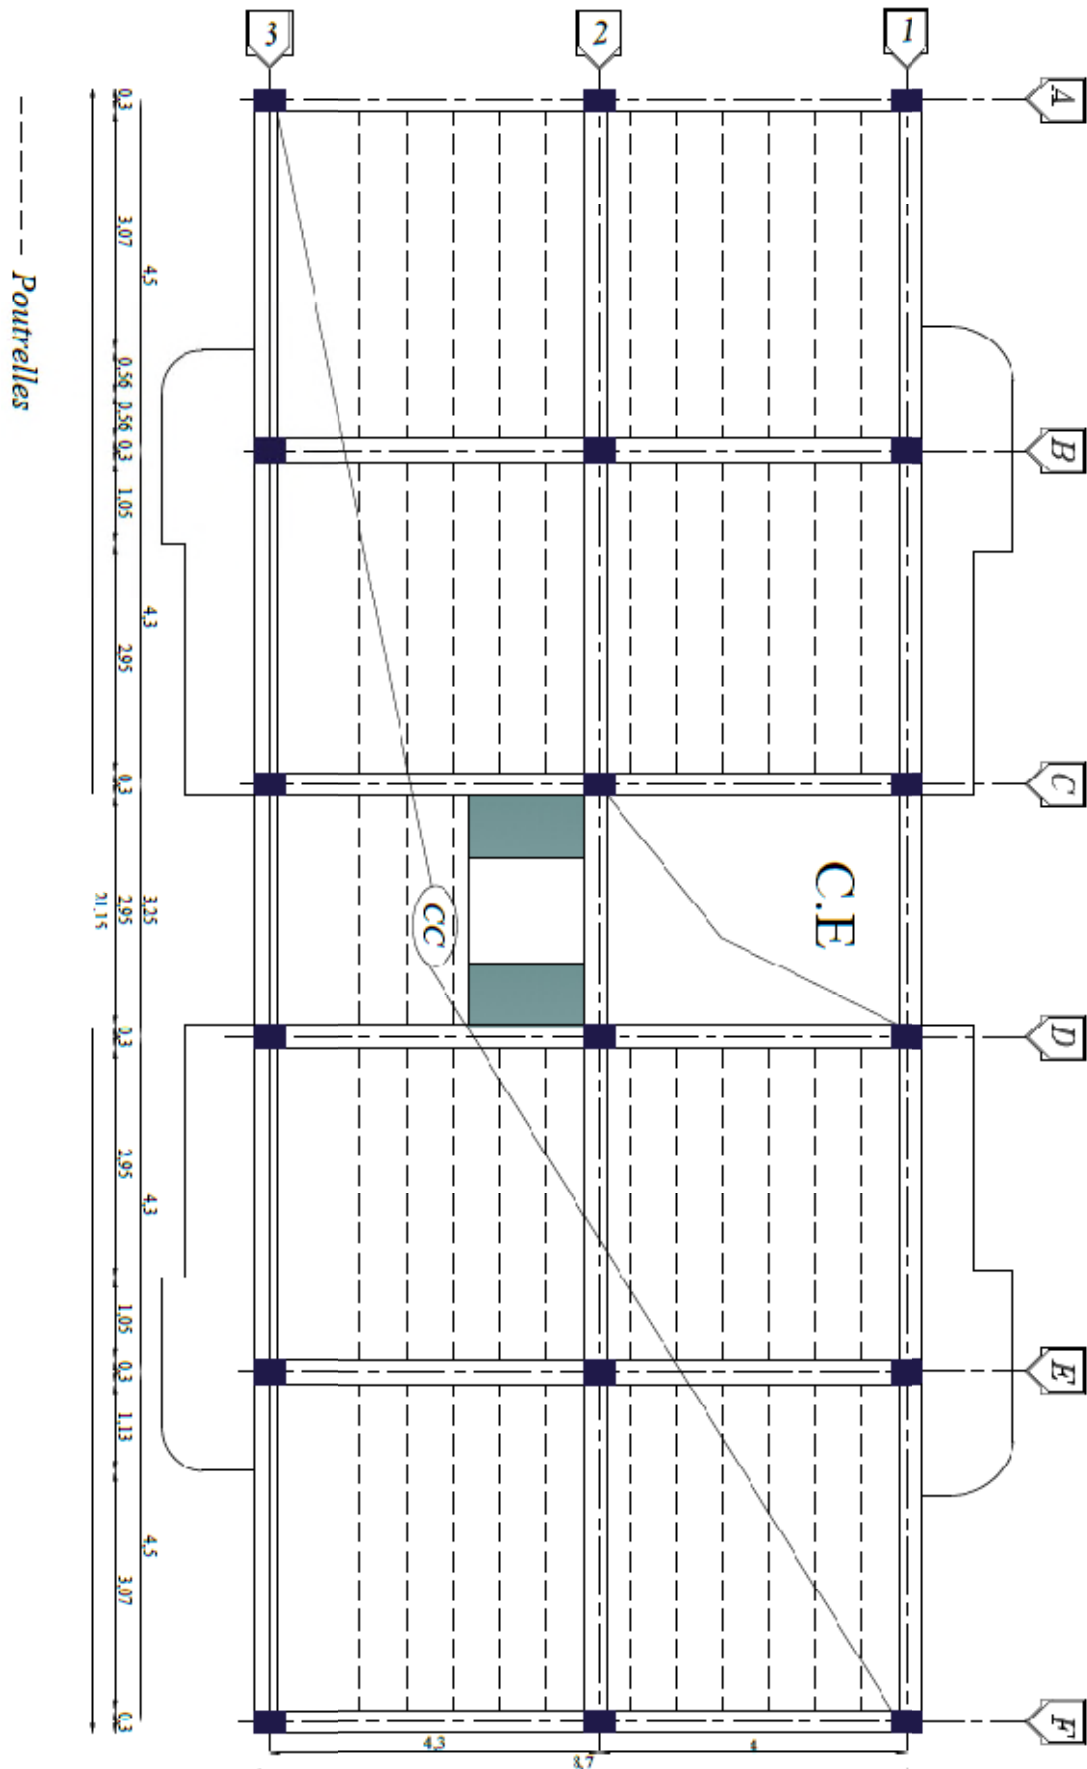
Sens de disposition des poutrelles à tous les niveaux
